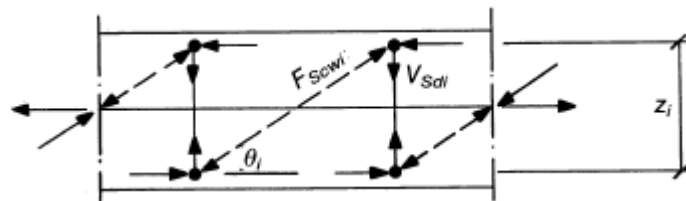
Modelo de treliça plana para uma parede. [9]
